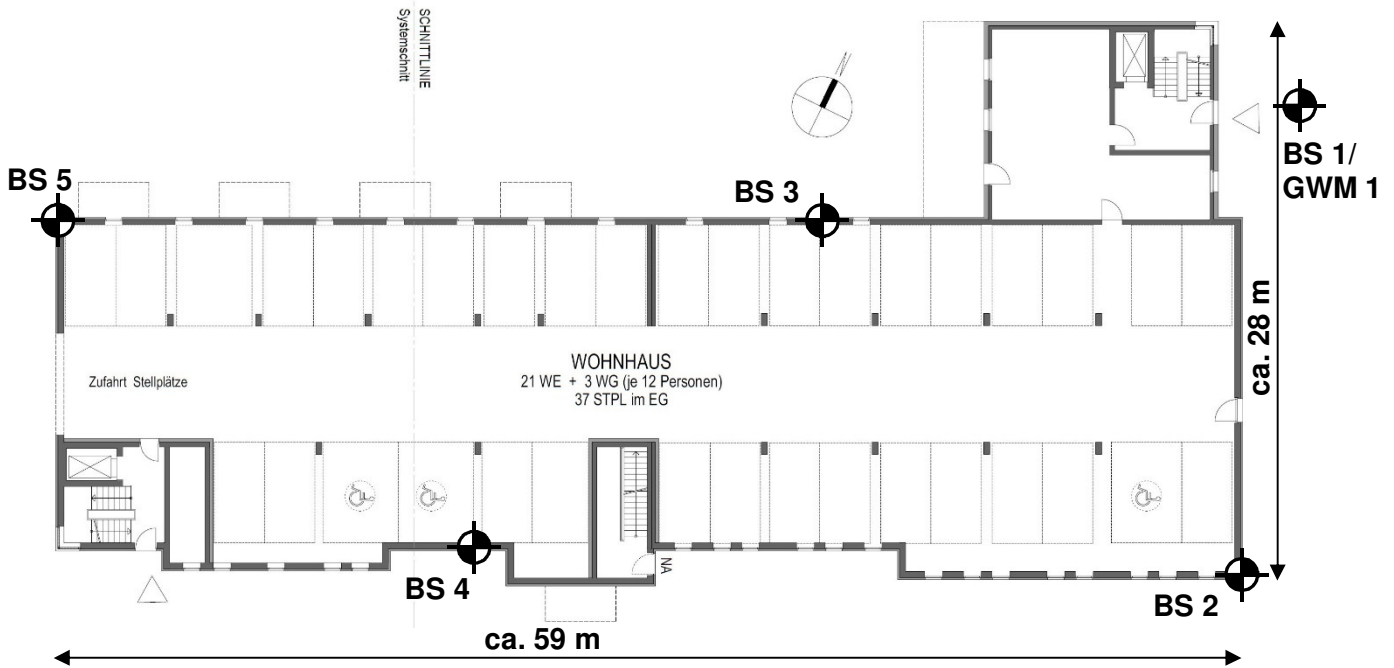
Erdgeschossgrundriss Haus 3, M 1:375
